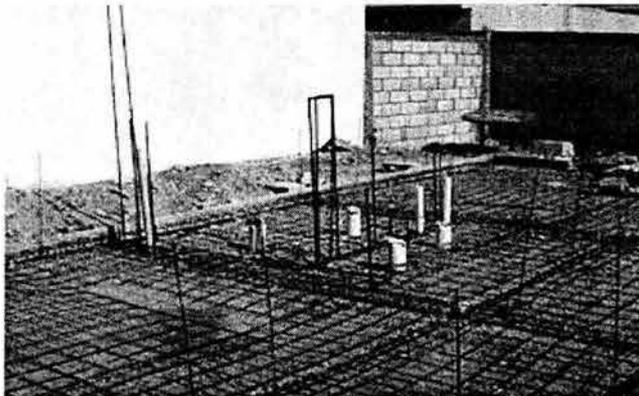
Acero de refuerzo en losa de cimentación y colocación de instalaciones hidráulicas y sanitarias ahogadas.
